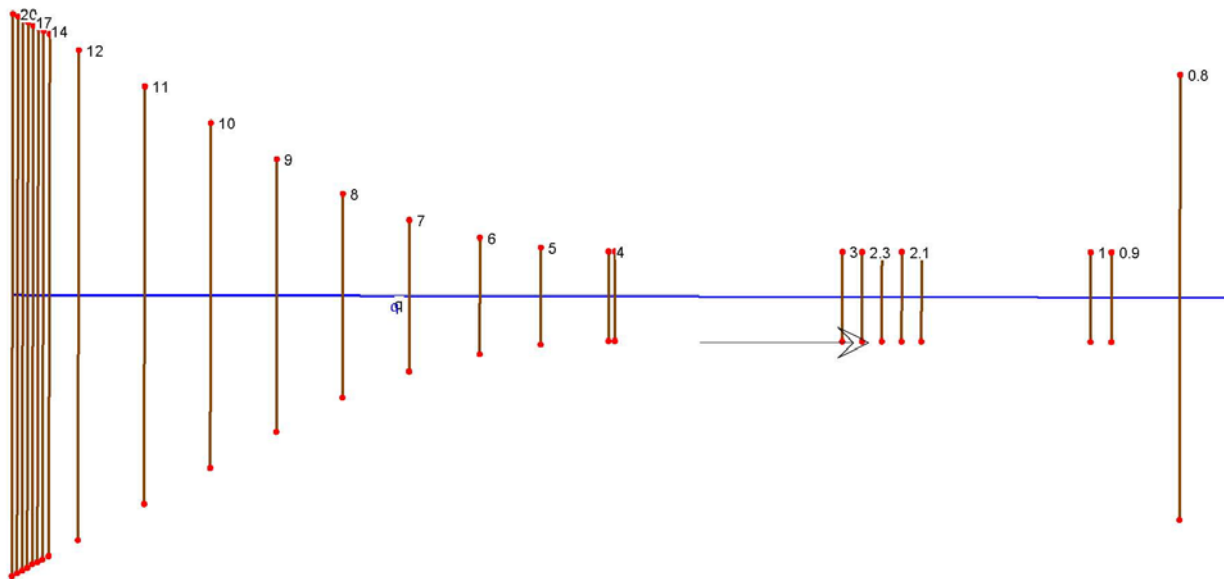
Schematizzazione planimetrica canale sfioratore (HEC-RAS)
